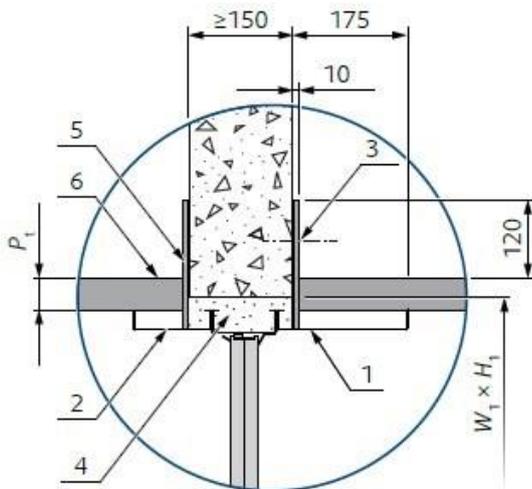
(E120S) Sezione trasversale di ① installazione umida in parete rigida
